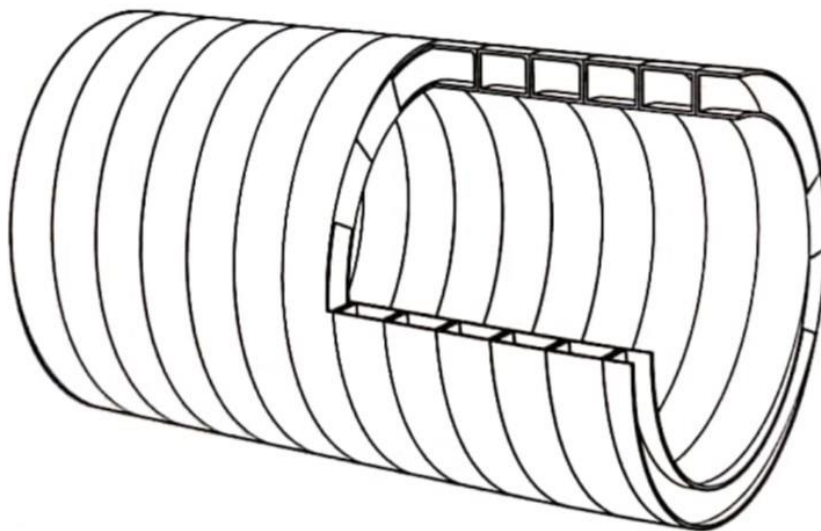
Tubos tipo A2 – parede oca espiralada ou radial - perfil box. (Fonte: DANIELLETO, 2014).
